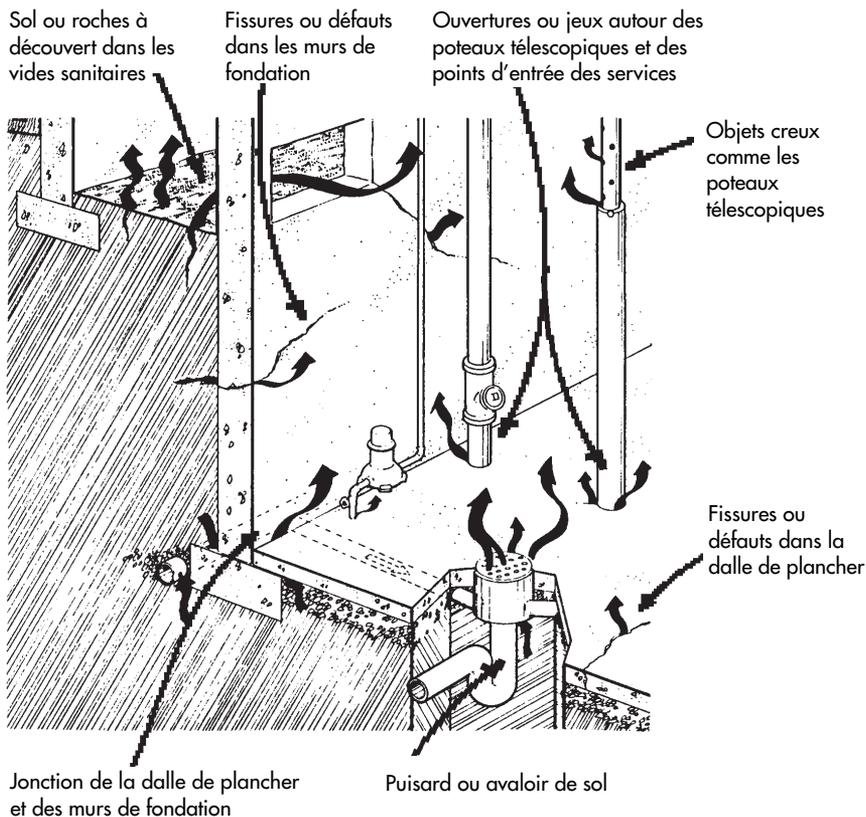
Points d'entrée habituels du radon dans les murs de fondation et les planchers en béton coulé
